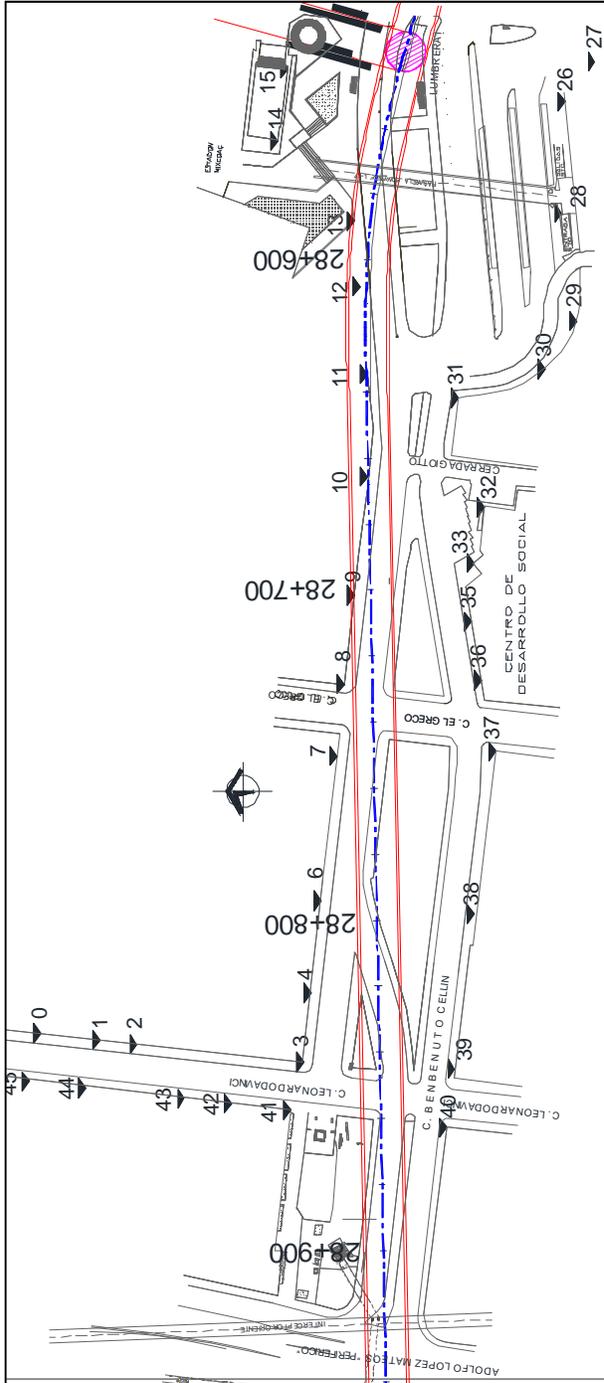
Vista en planta de la colocación de las niveletas del tramo Lumbra 1-Periférico Sur
